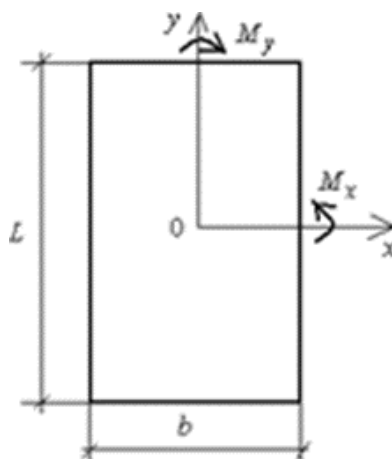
Схема до визначення моментів опору підшви фундаменту
